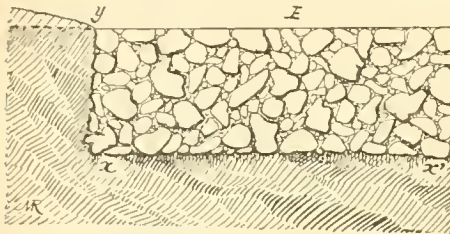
Coupe verticale d'un empierrement sur un sol résistant.
